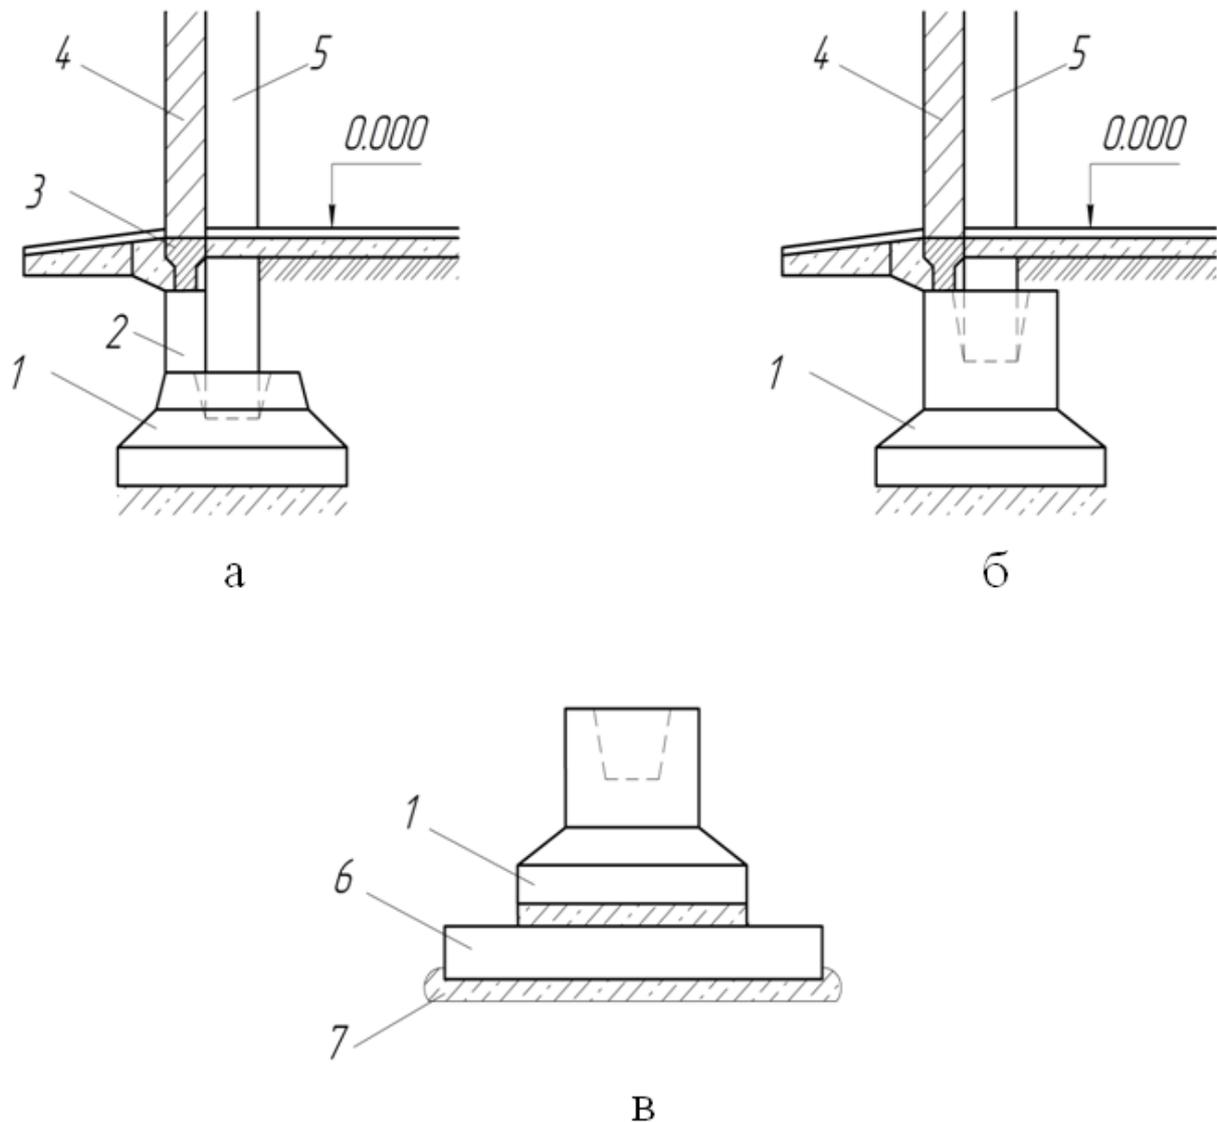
Железобетонные фундаменты под колонны: а – стаканного типа; б – с повышенным стаканом; в – составной фундамент; 1 – фундамент стаканного типа; 2 – бетонный столбик; 3 – фундаментная балка; 4 – самонесущая стена; 5 – колонна; 6 – плита; 7 – бетонная подготовка
